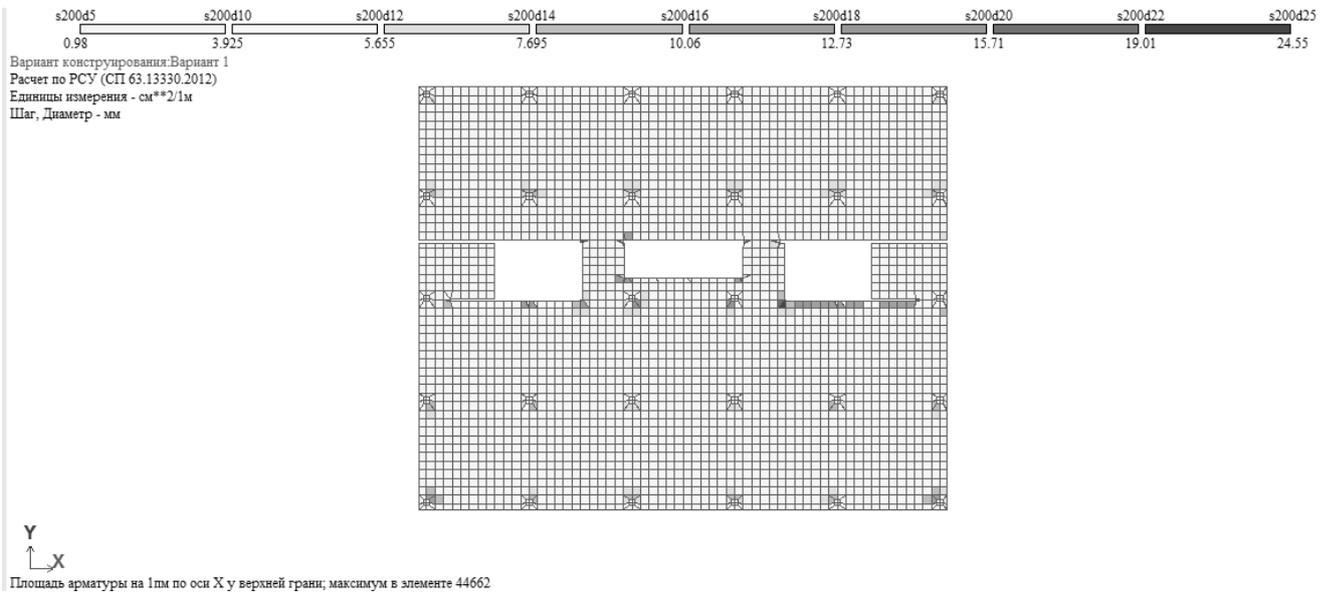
Верхнее армирование плиты перекрытия по оси X
